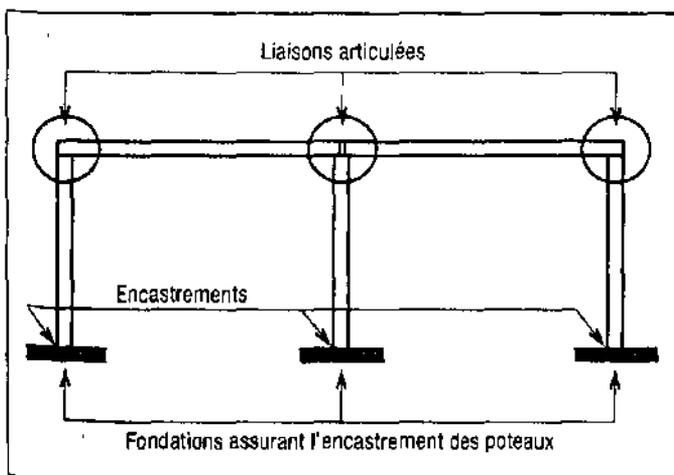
Liaison étudiée : encastrement en pied de poteau.
